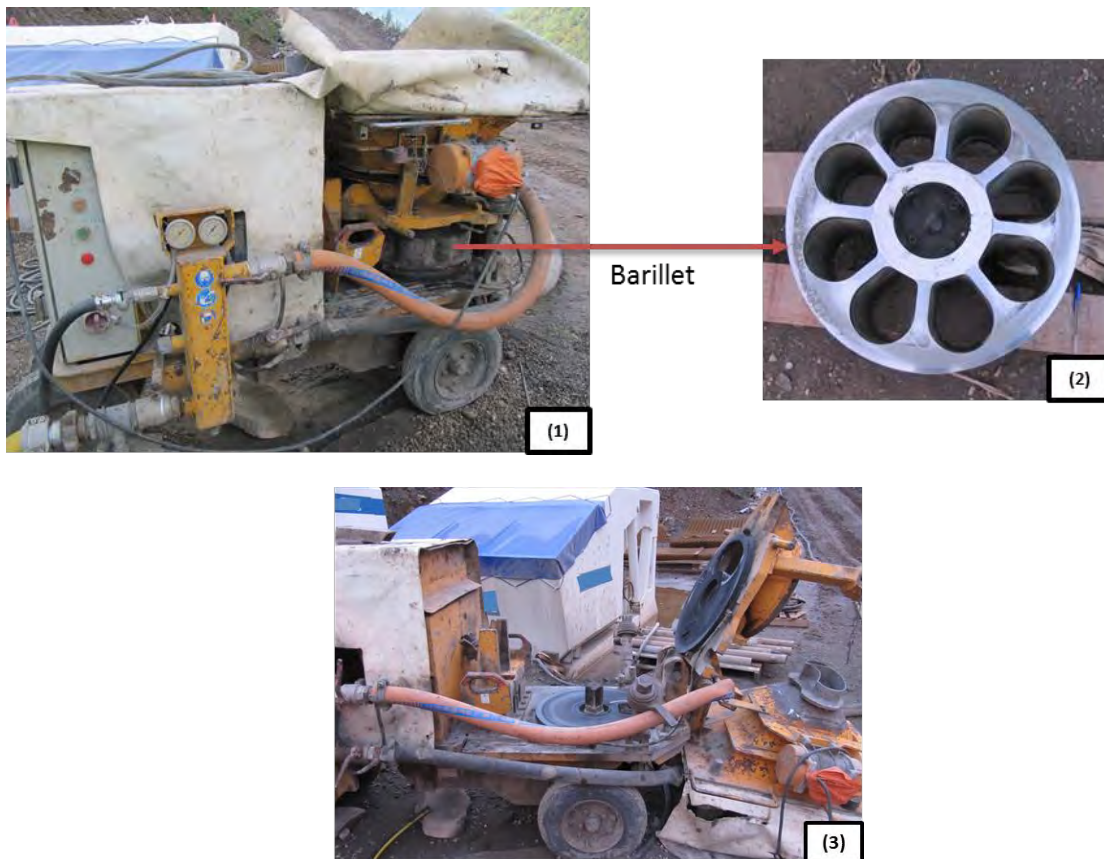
Machine à Rotor fermée (1), barillet (2), machine ouverte sans barillet (3)
